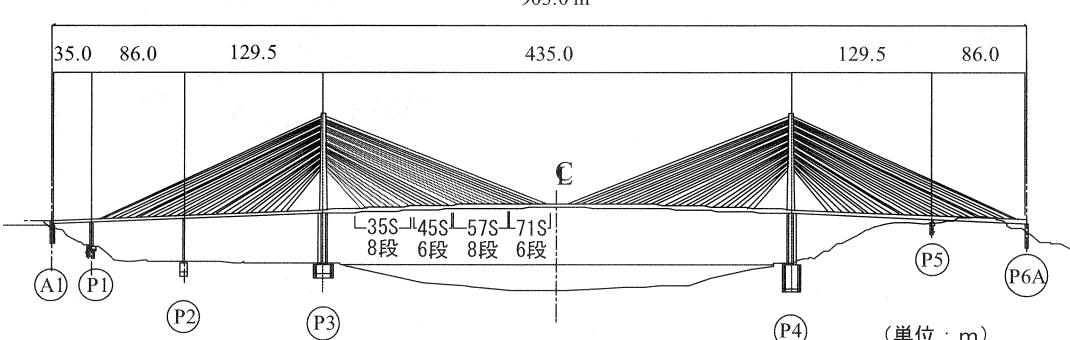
斜ケーブル配置図（主塔と支間中央に対して対称配置）
